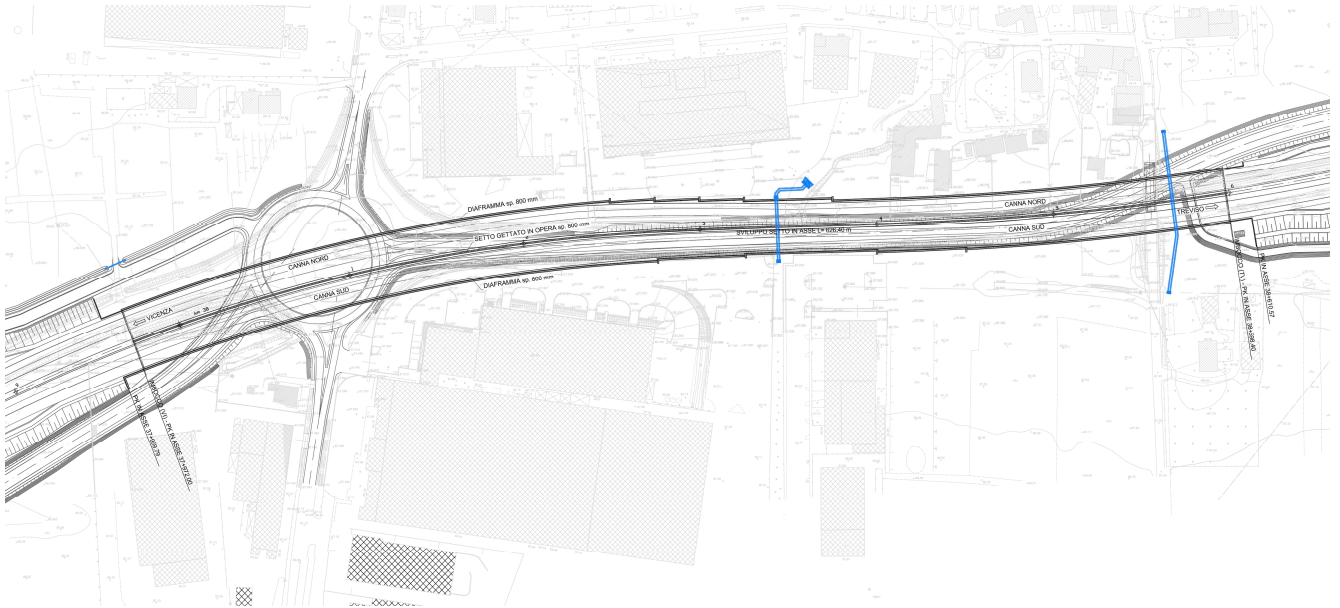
schema planimetrico della galleria artificiale Marostica Ovest.
